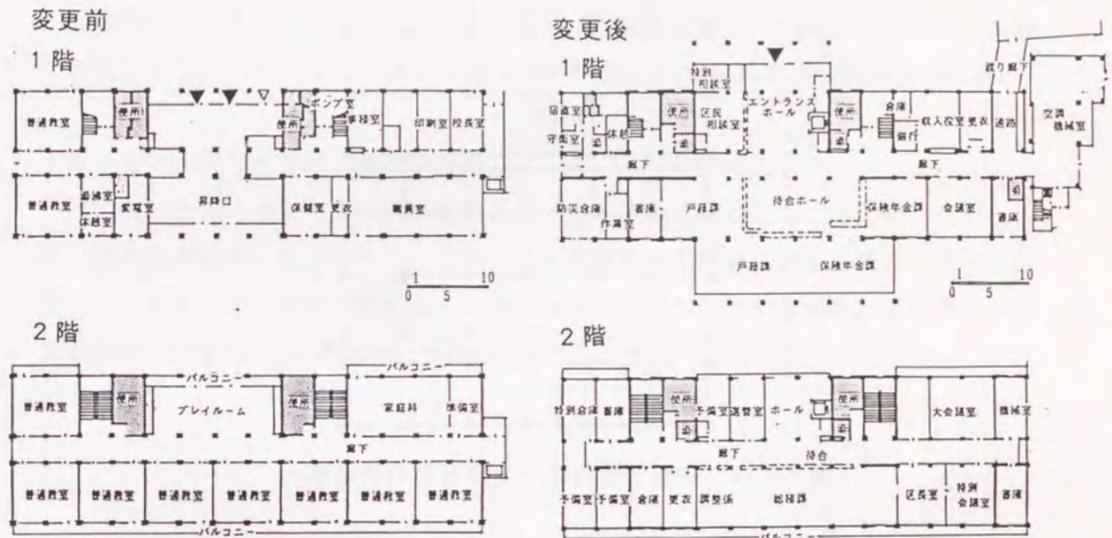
<46>横浜市栄区役所(旧小学校)1, 2階平面図
